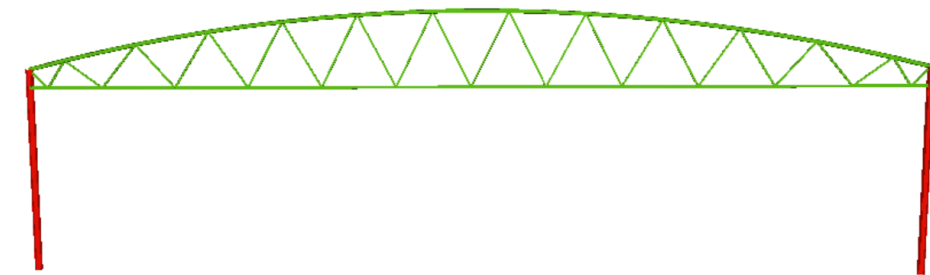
Pórtico tipo de la estructura principal. Fuente: Propia
